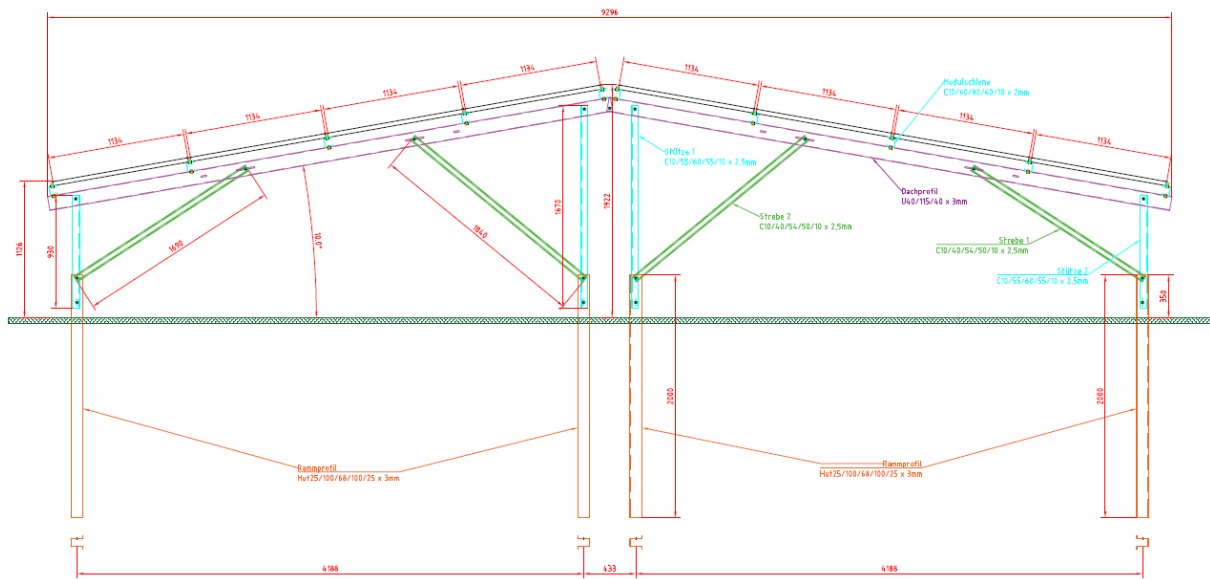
Geplante Unterkonstruktion mit 10° Modulneigungswinkel
